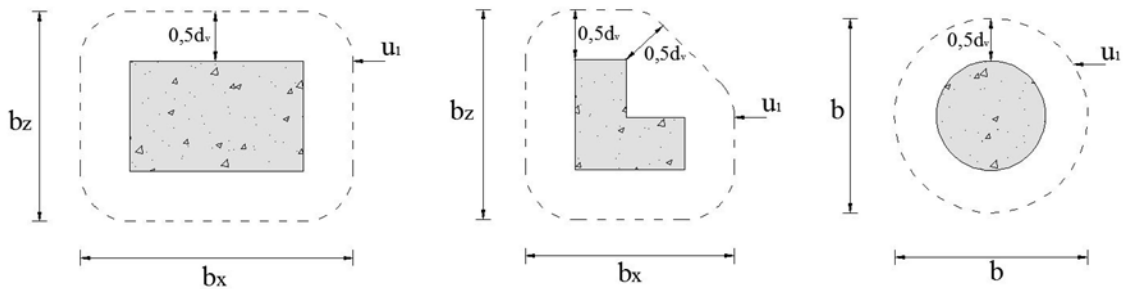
Perímetro de controlo para pilares centrados, segundo MC2010 [6]
